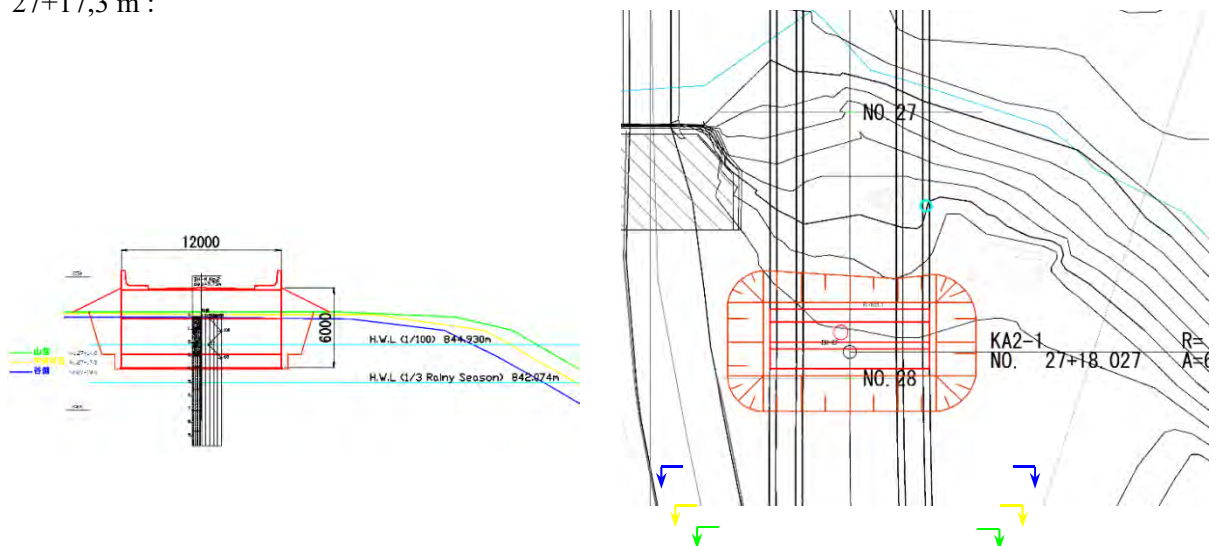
Variantes de l'emplacement de la culée A2 (vue transversale et vue en plan)
